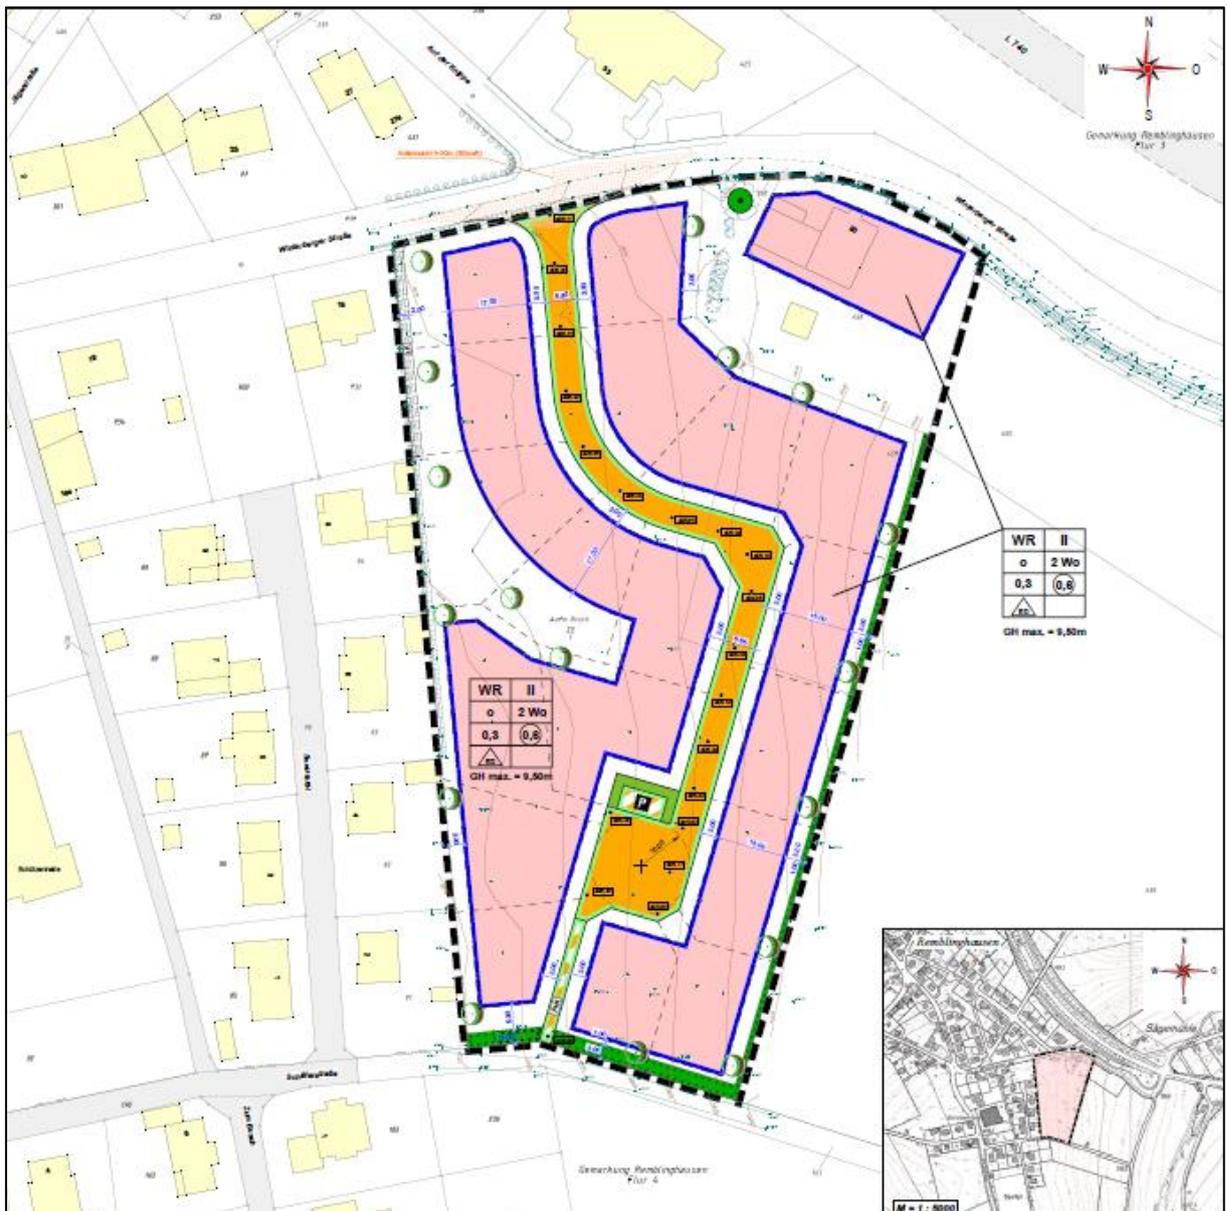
Auszug des Bebauungsplans Nr. 147 „Winterberger Straße“ Stadt Meschede, Gemarkung Remblinghausen, Flur 3 (FINGER BAUPLAN GMBH 2024b).
